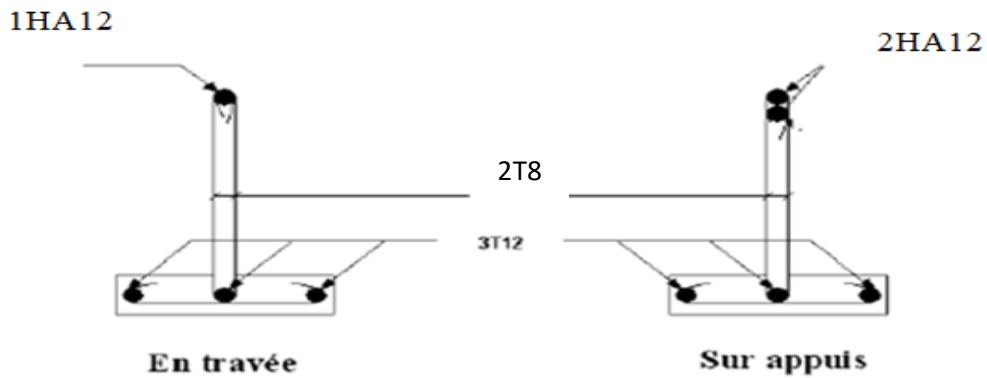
Schéma ferrailage des poutrelles en travées et sur appuis.
